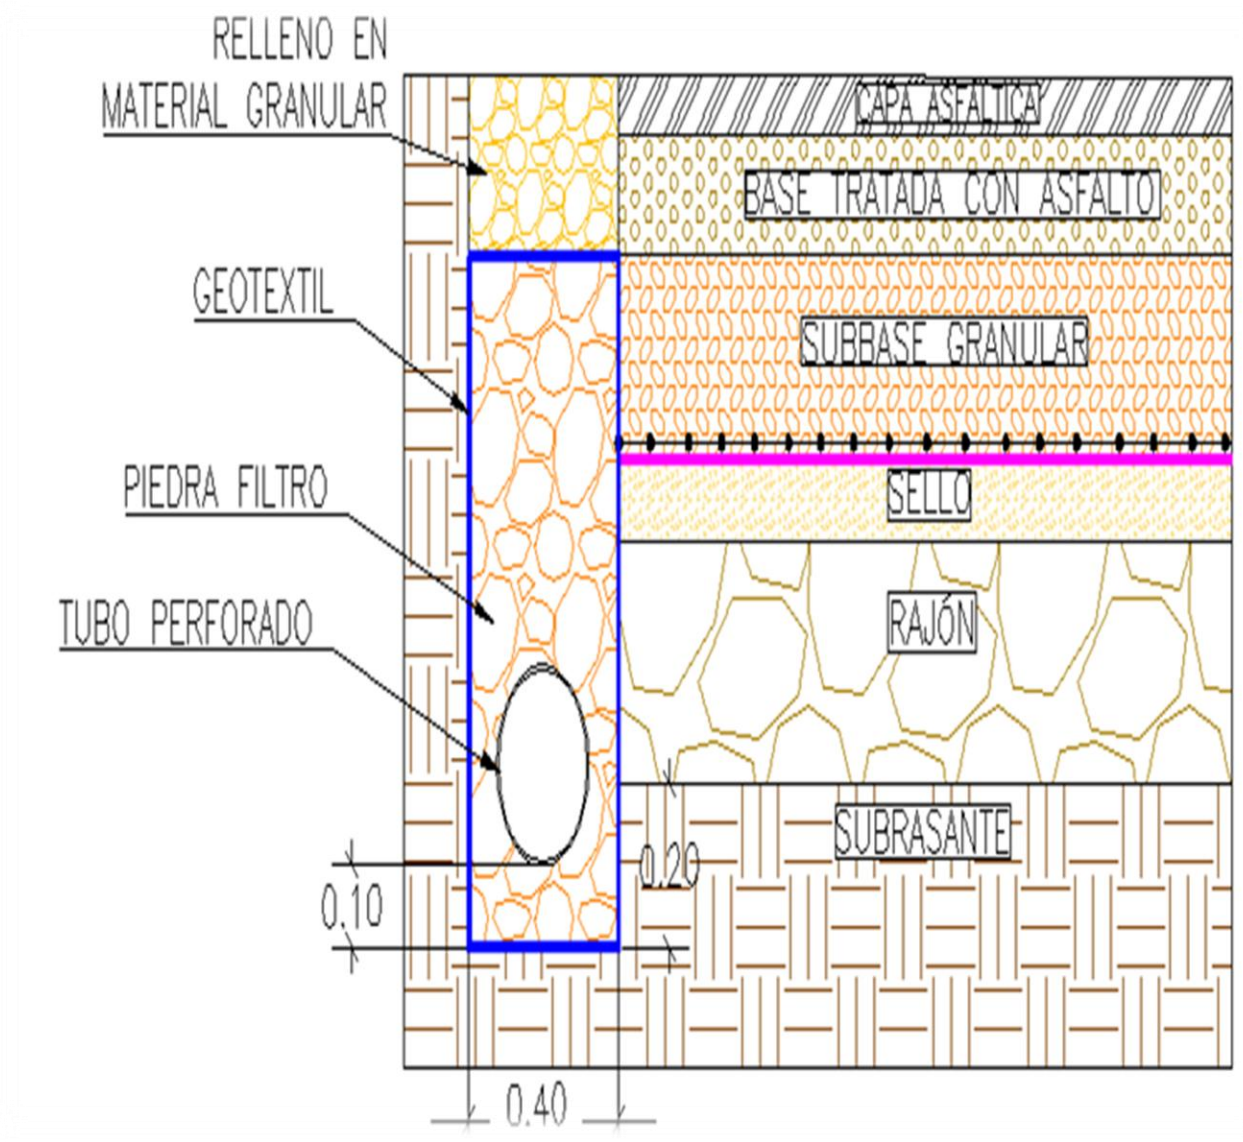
Ilustración II Diseño de Estructura de Pavimento a Ejecutar
